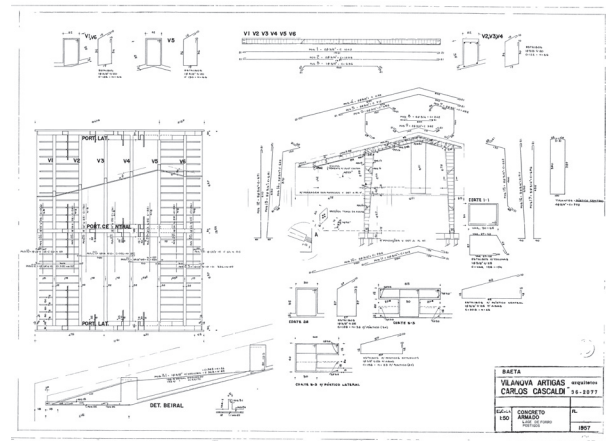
| Projeto estrutural - laje e pórticos - Projeto Executivo da Casa Olga Baeta
